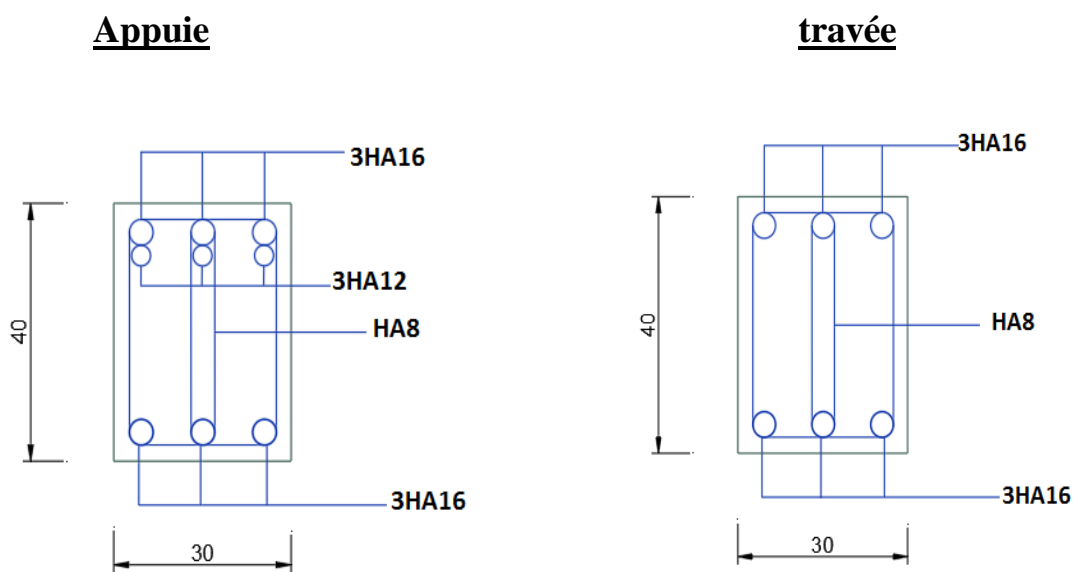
Schéma de ferrailage de poutre secondaire 30x40.
